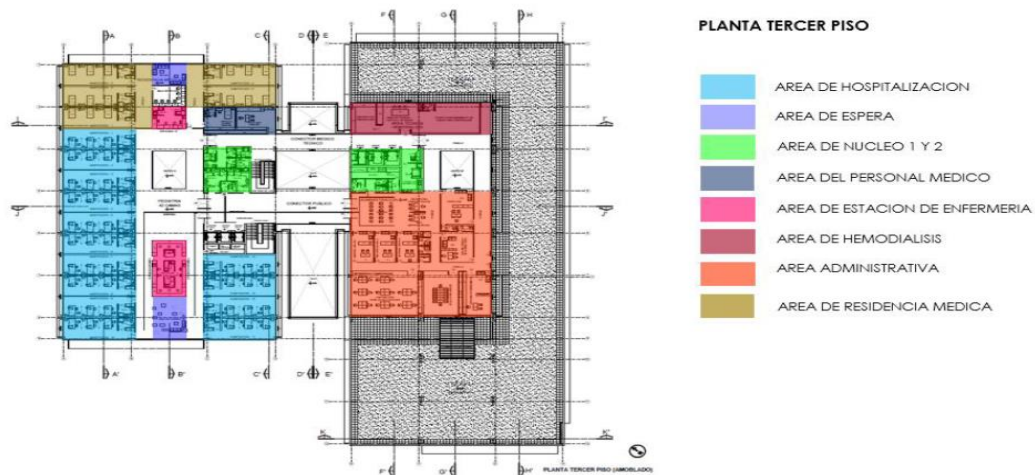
Zonificación de la planta tercer piso del proyecto n°3.
